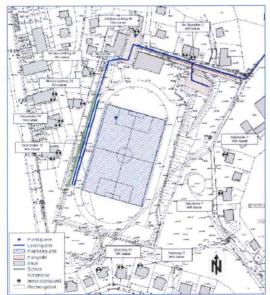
Lageplan Lärmschutz, Büro Rehm
